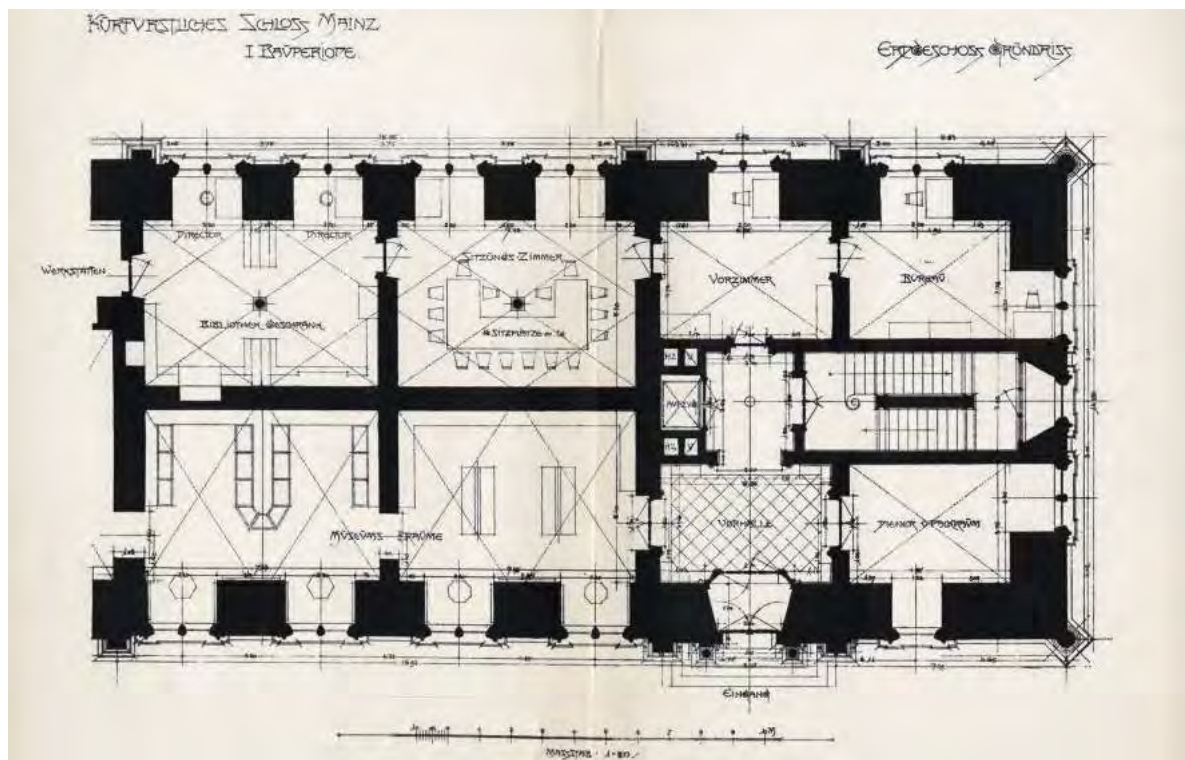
Rudolf Opfermann: Kurfürstliches Schloss, Teil-Grundriss des Erdgeschosses im Rheinflügel mit erstem unausgeführten Treppenprojekt sowie Gewölberäumen, 1901.
